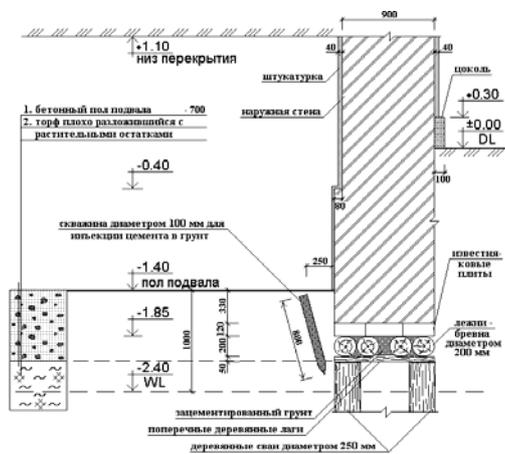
Конструкция фундаментов здания на 4-й Советской ул., 42
